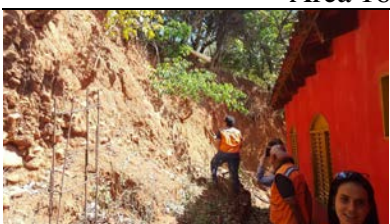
Construções em taludes, sem drenagem pluvial, acompanhamento da equipe de empresa vinculada à CODHAB e equipe de arquitetura da Defesa Civil.
